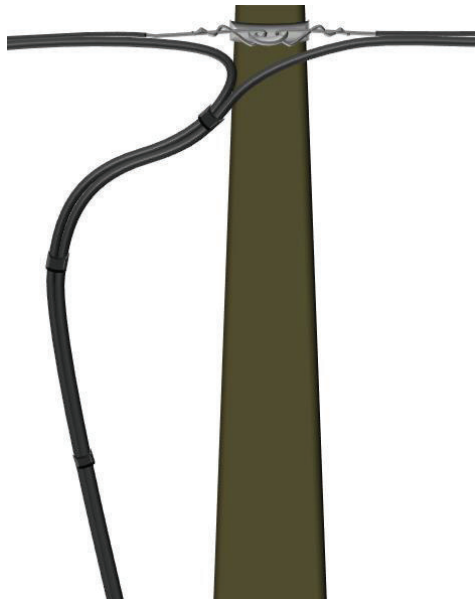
Paso 1 armado de mangas: Empaquetado
